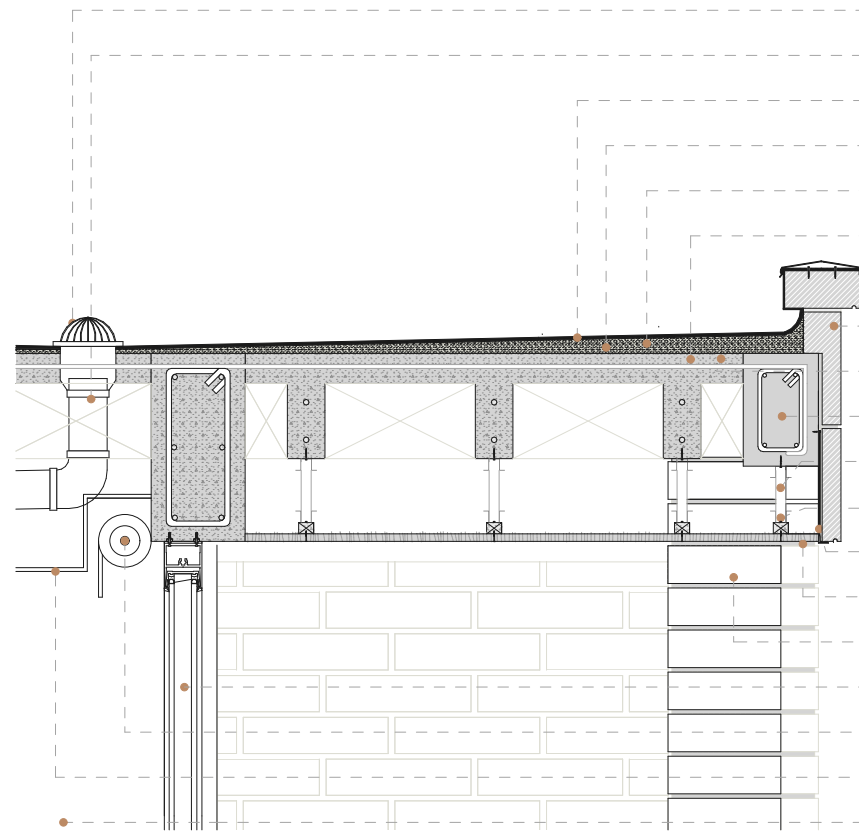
Detalle cubierta. Fuente: Autoría propia.
